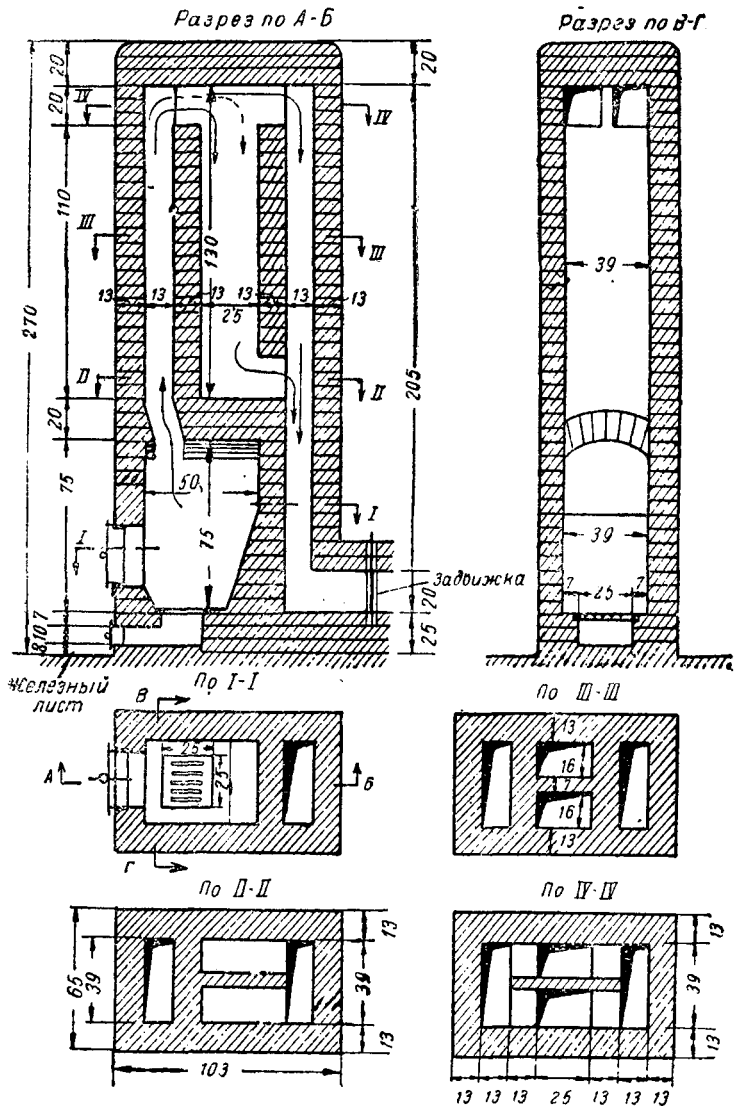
План и разрезы кирпичной печи (к примеру 3).
